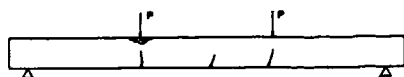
Grietas en el estado de rotura de una viga muy débilmente armada (cuantía 0,2%) Citado por Bukowski¹.
